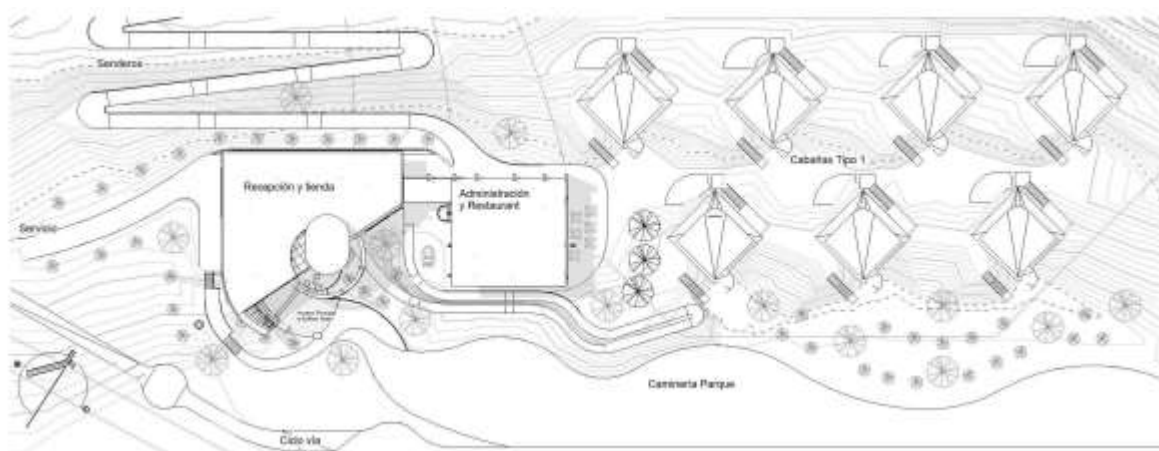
Planta de sub conjunto compuesto por el Edificio Sede y las cabañas.
